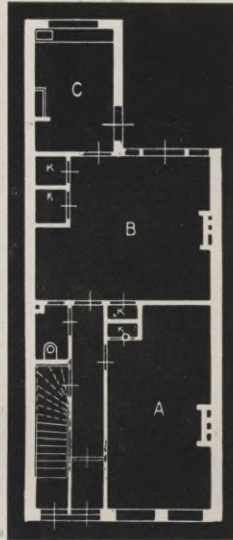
Kleinwohnung, neuere Bauform. Grundriß des Erdgeschosses.
